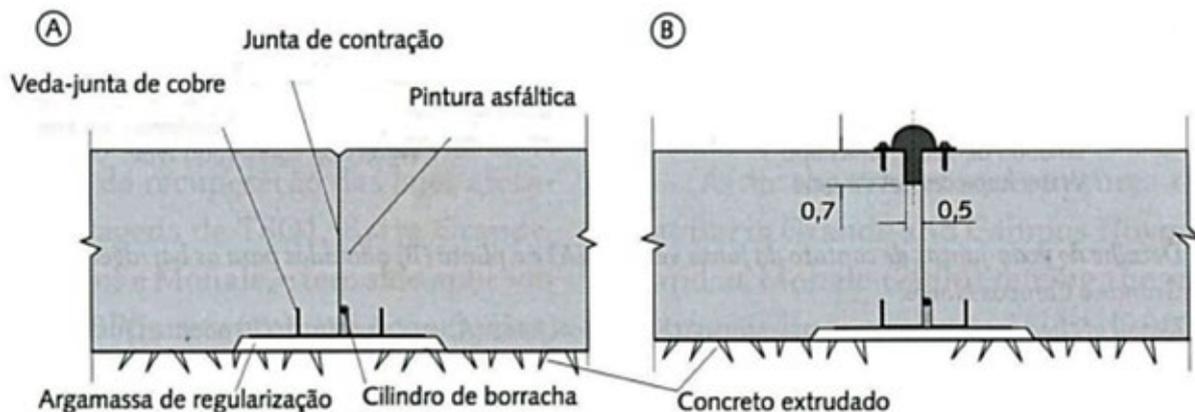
Juntas verticais: A) Campos Novos, área central (zona de compressão); B) Barra Grande, RS/SC, ombreiras (zona de tensão).
